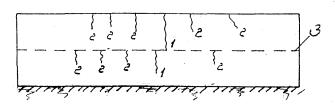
Расположение усадочных трещин на монолитной железобетонной стене резервуара 1,2 - трещины от усадки; 3 - рабочий шов бетонирования
